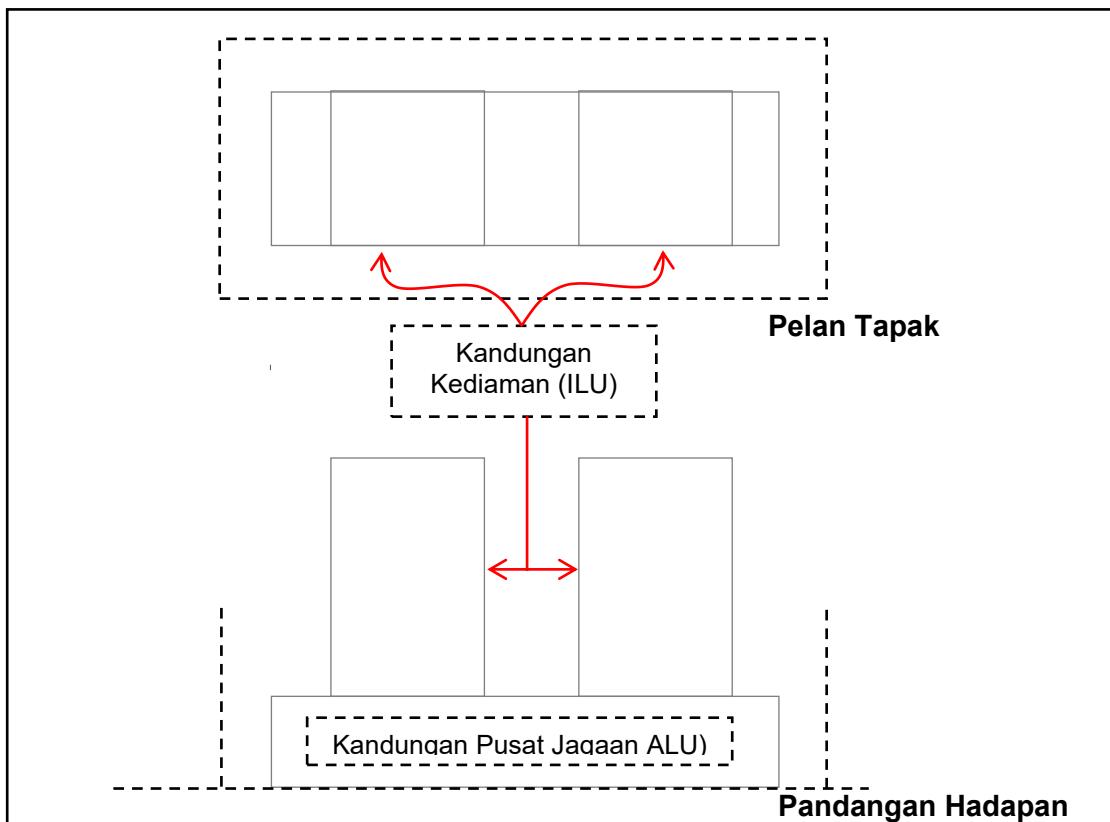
Perumahan Mesra Warga Emas yang disediakan secara bangunan berasingan (free standing building)
